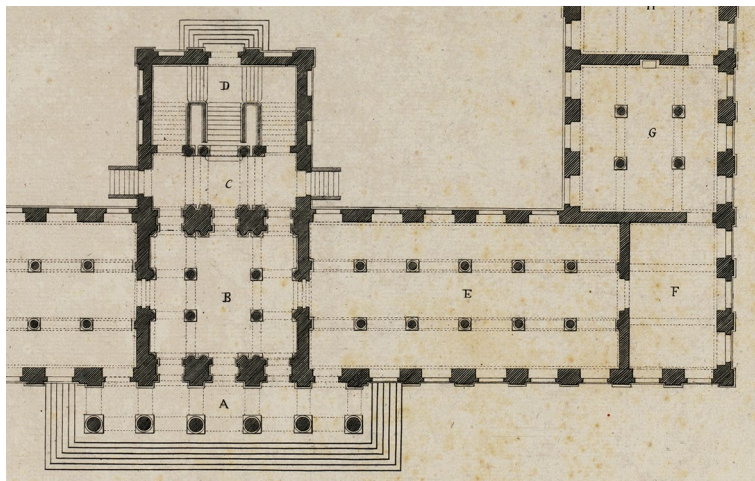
John. Karl Müller/Simon Louis Du Ry, [Grundriss des Museum Fridericianum](#), 1784. Detail des Erdgeschosses mit »Salle tetrastile« (G).
